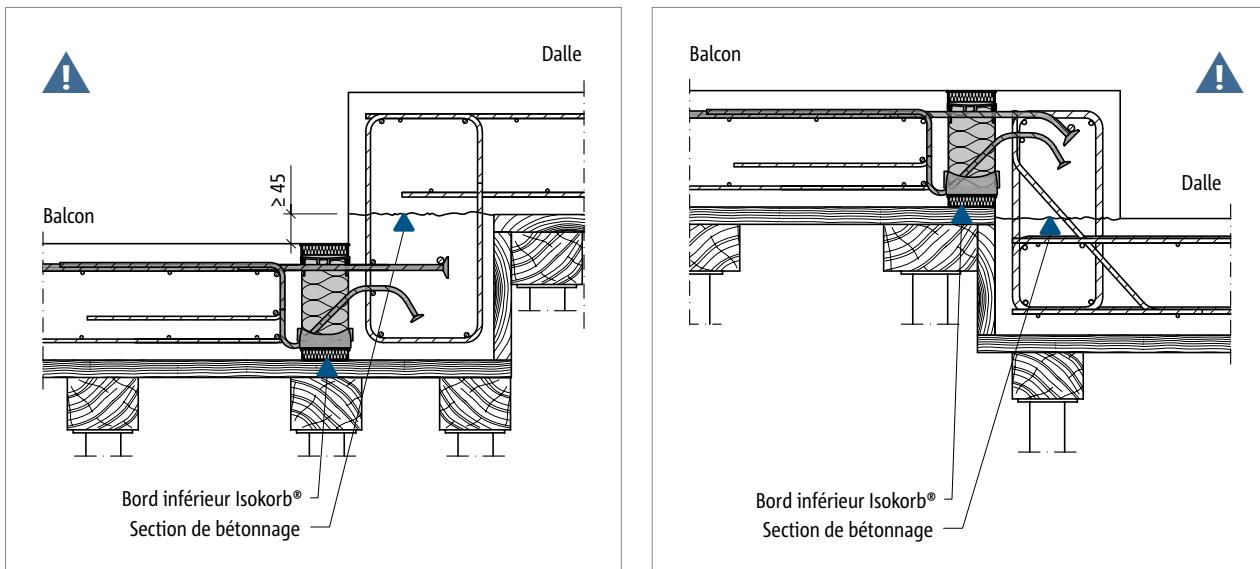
Schöck Isokorb® T type K-U : balcon en béton coulé sur site avec décalage vers le bas
